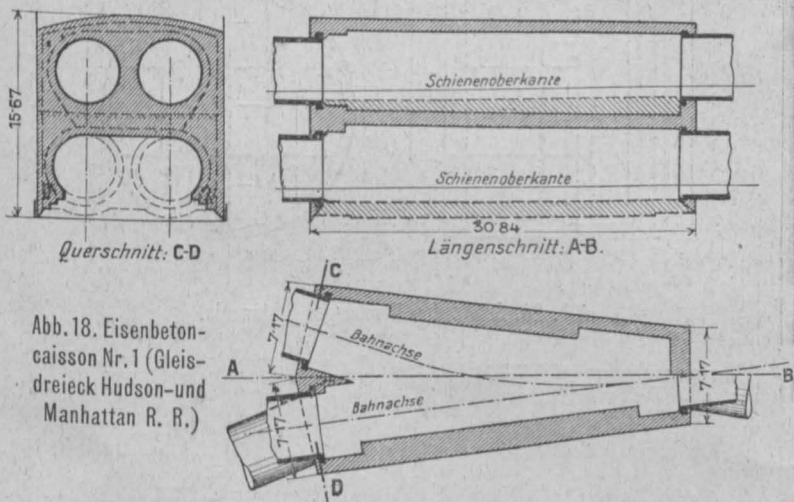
Eisenbeton-caisson Nr. 1 (Gleisdreieck Hudson- und Manhattan R. R.)
